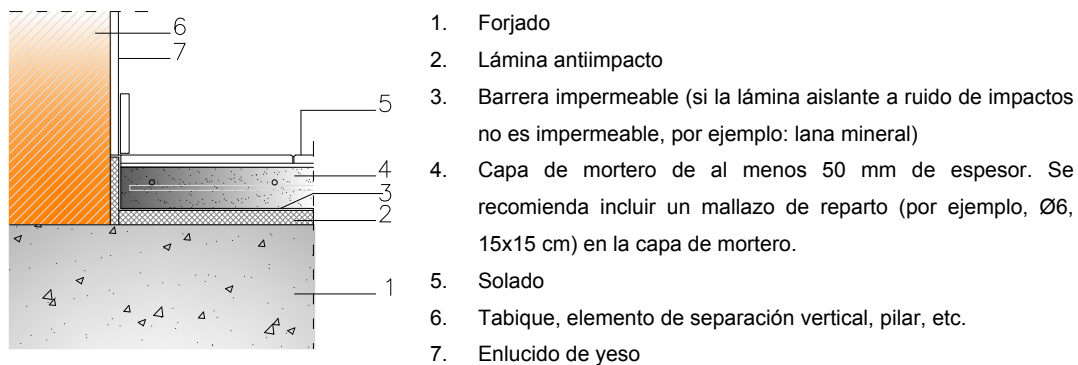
Detalle encuentro de un suelo flotante con los paramentos y pilares.
